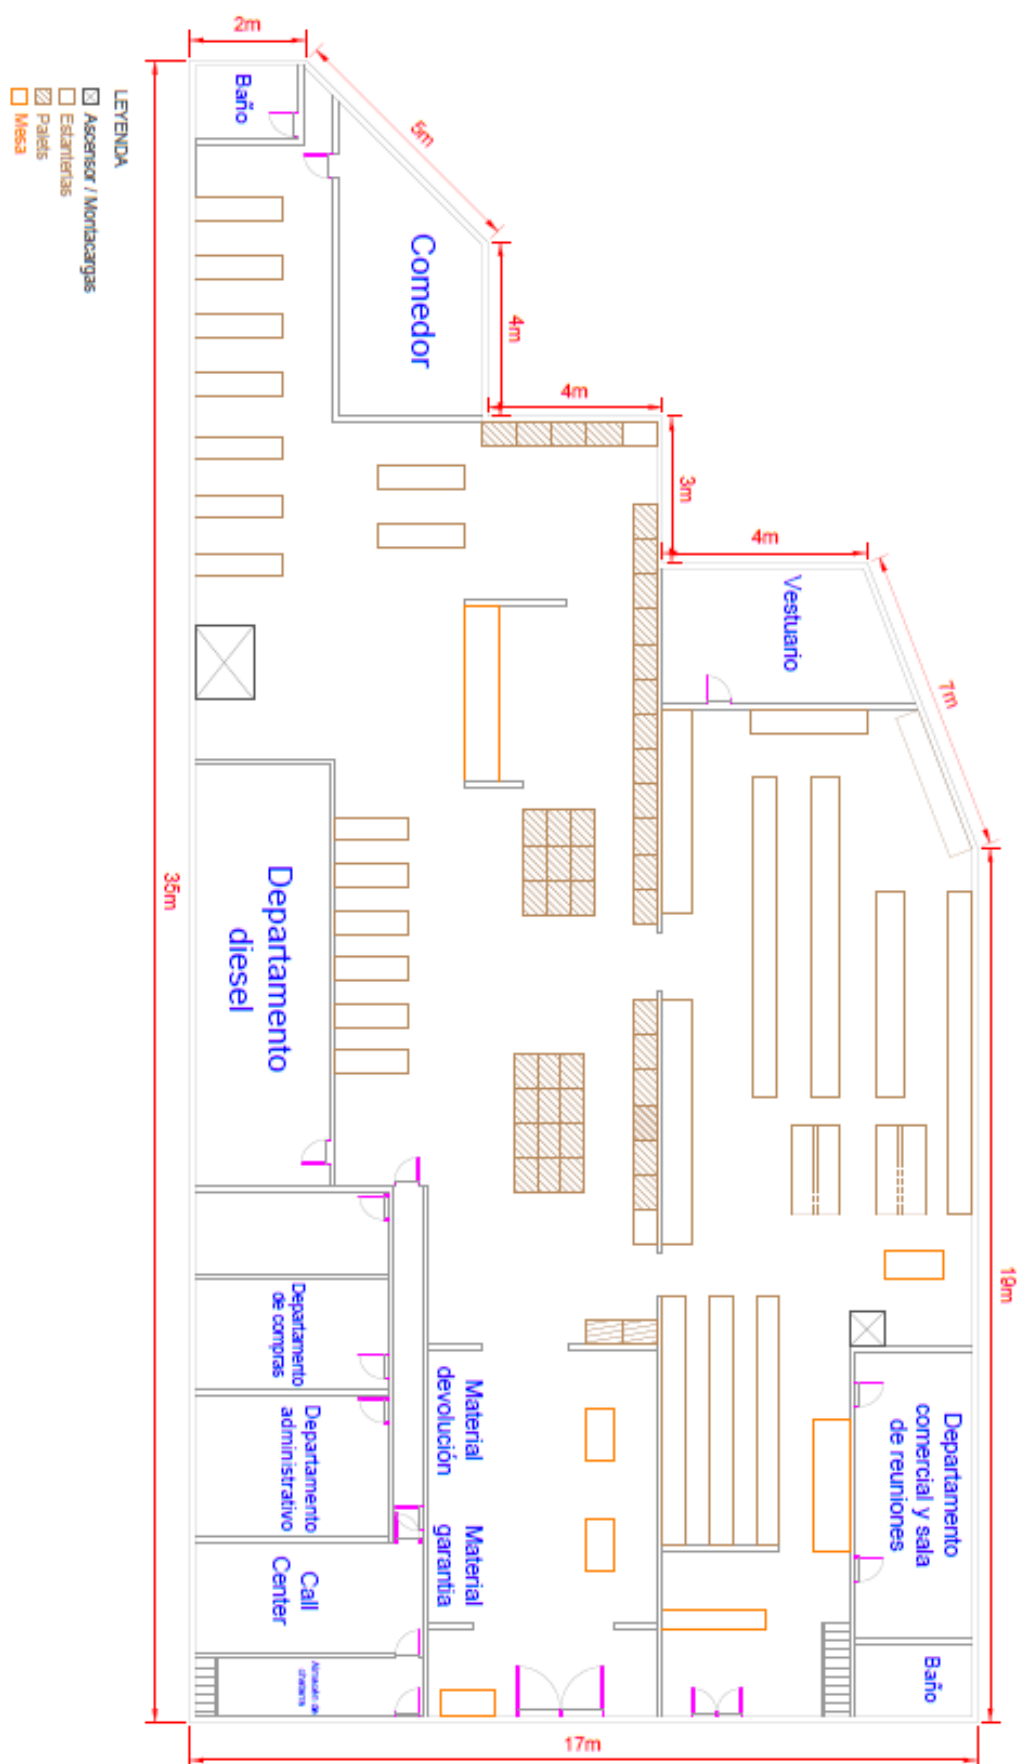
Imagen del plano de la planta baja (Anexo D: P001)
